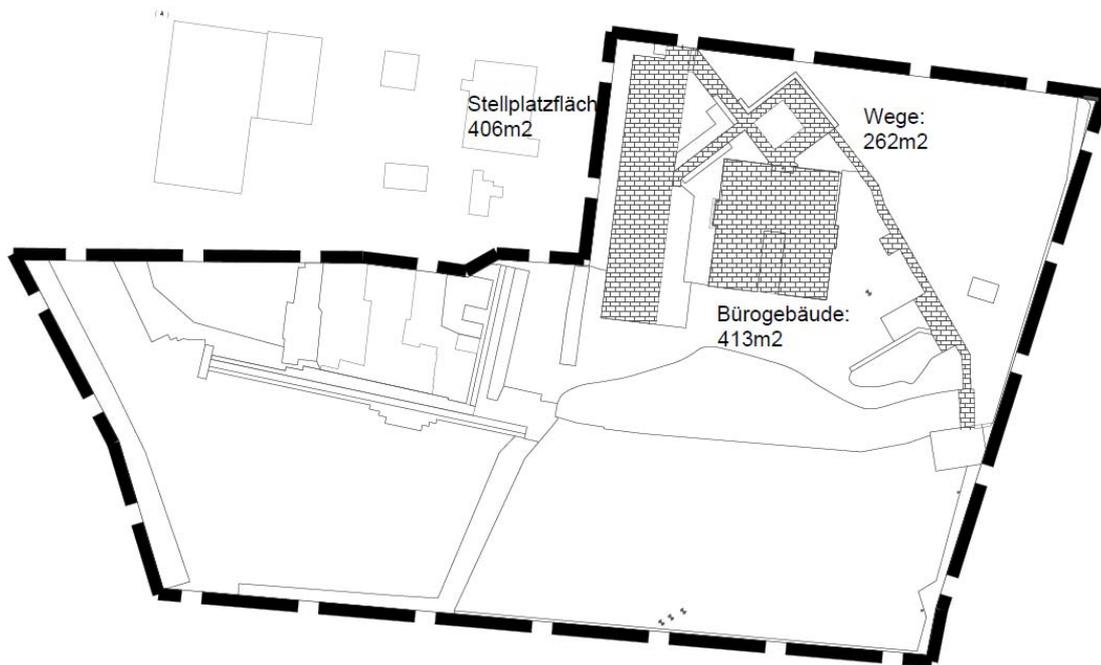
Vor der planerischen Entscheidung auf Grundlage der Baugenehmigung zulässiger Eingriff (zulässige Versiegelung, dargestellt durch Schraffur)
